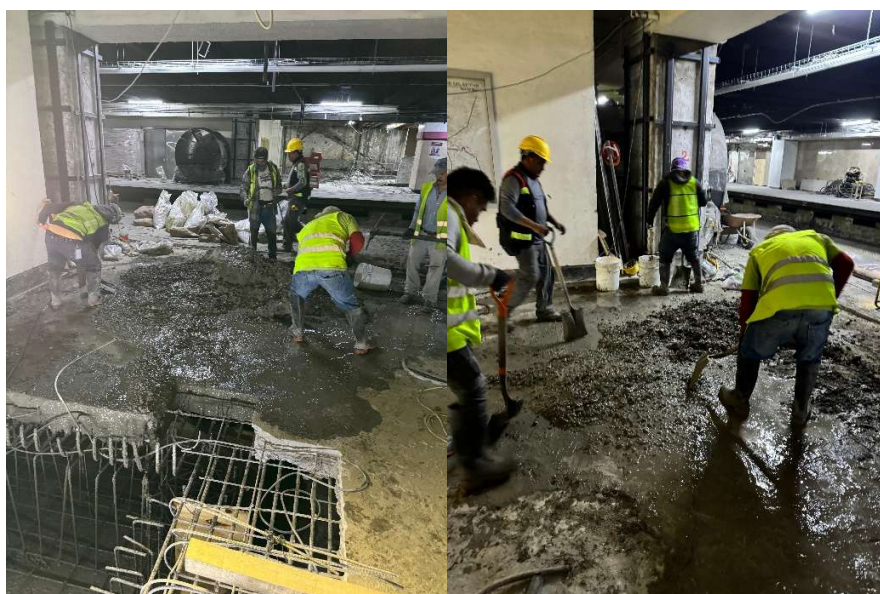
Colado de zapata de cimentación de elevador. Elaborado por el autor.
